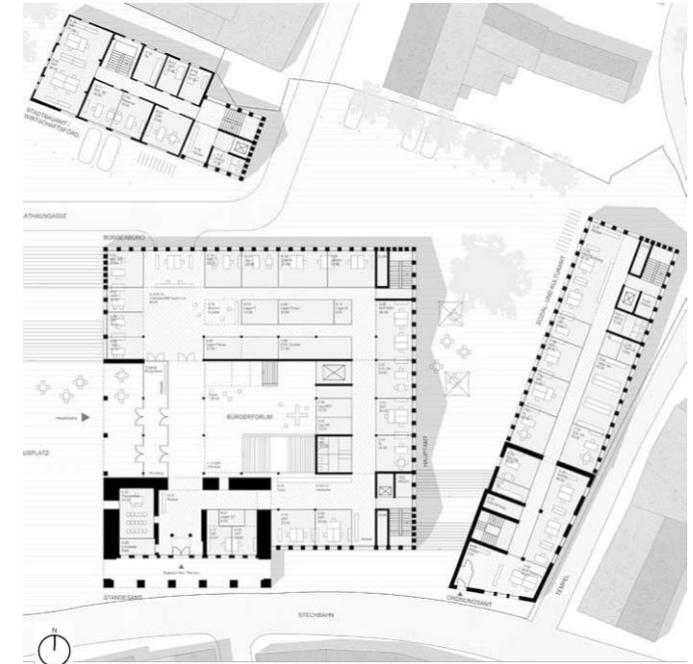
Grundriss, Erdgeschoss, Verbindung des Ursprungsbaus aus 1377 mit dem Neubau
